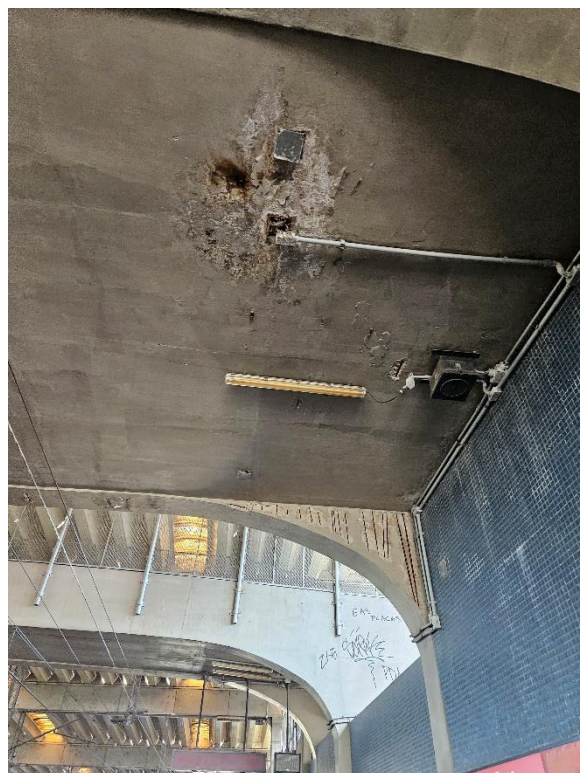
Passarela e Mezanino Operacional – Lajes com infiltração e ferragens expostas
